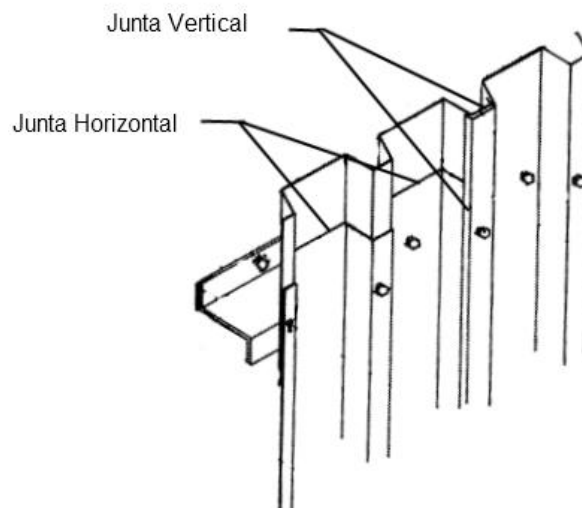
Juntas verticais e horizontais em ligações entre chapas perfiladas. Adaptado de [18].
